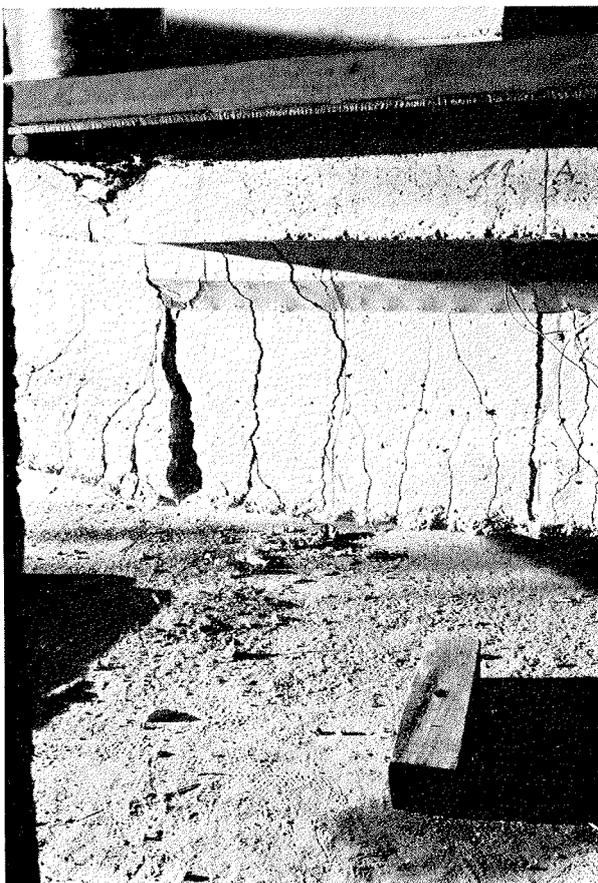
Detalle de la rotura de la losa en la viga tipo C.
